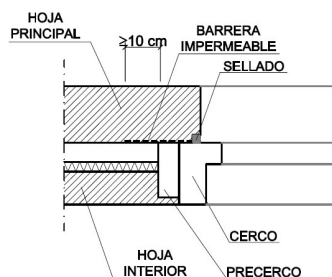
Ejemplo de encuentro de la fachada con la carpintería
